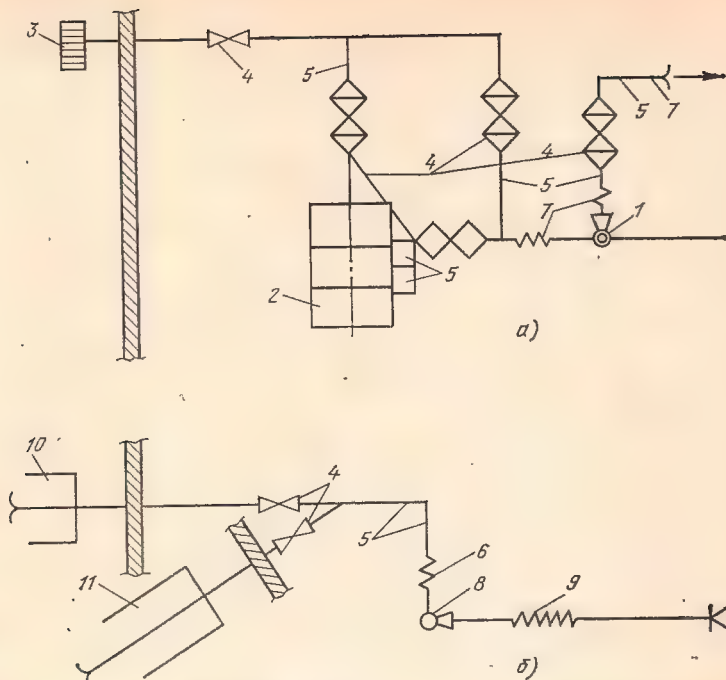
Схема фильтровентиляции убежища с фильтровентиляционной установкой с расходом воздуха 300 м³/ч:
